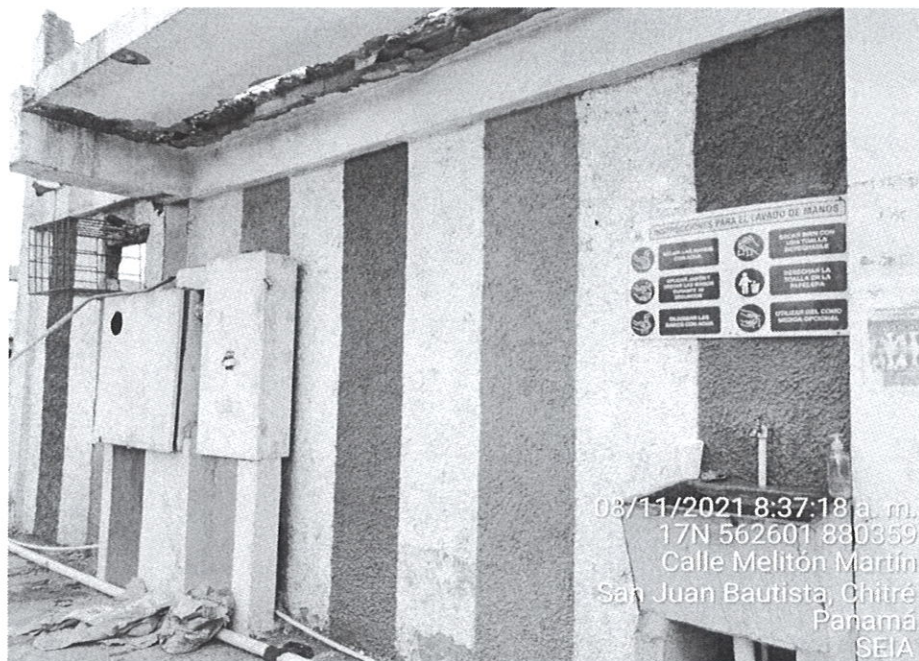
Se observa pared en donde está instalado un grifo de agua potable, letrero con información sobre instrucciones para el lavado de manos, además de instalación de cajas de metal para suministro de energía eléctrica.
